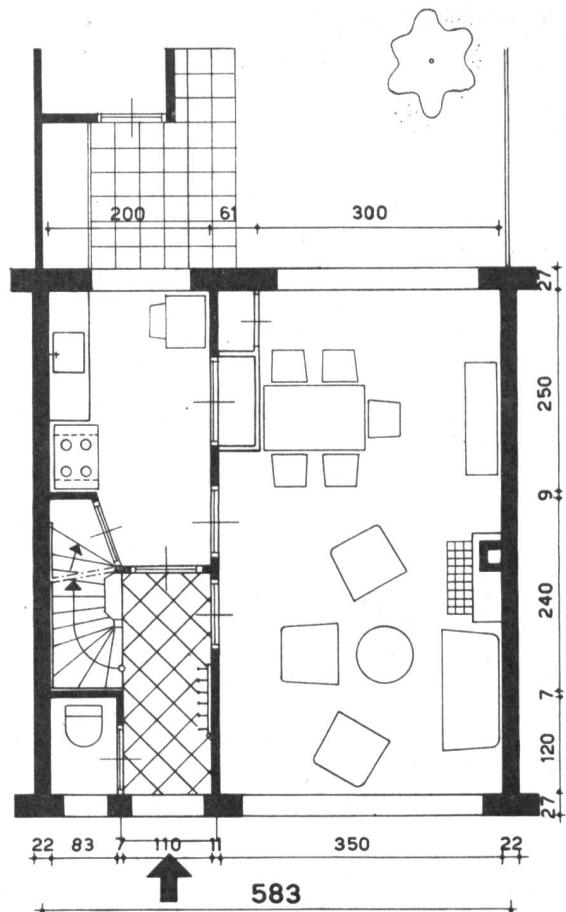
Typischer Grundriss eines holländischen Reihen-Einfamilienhauses. Im Erdgeschoss ist der grosse Wohnraum quergestellt.
